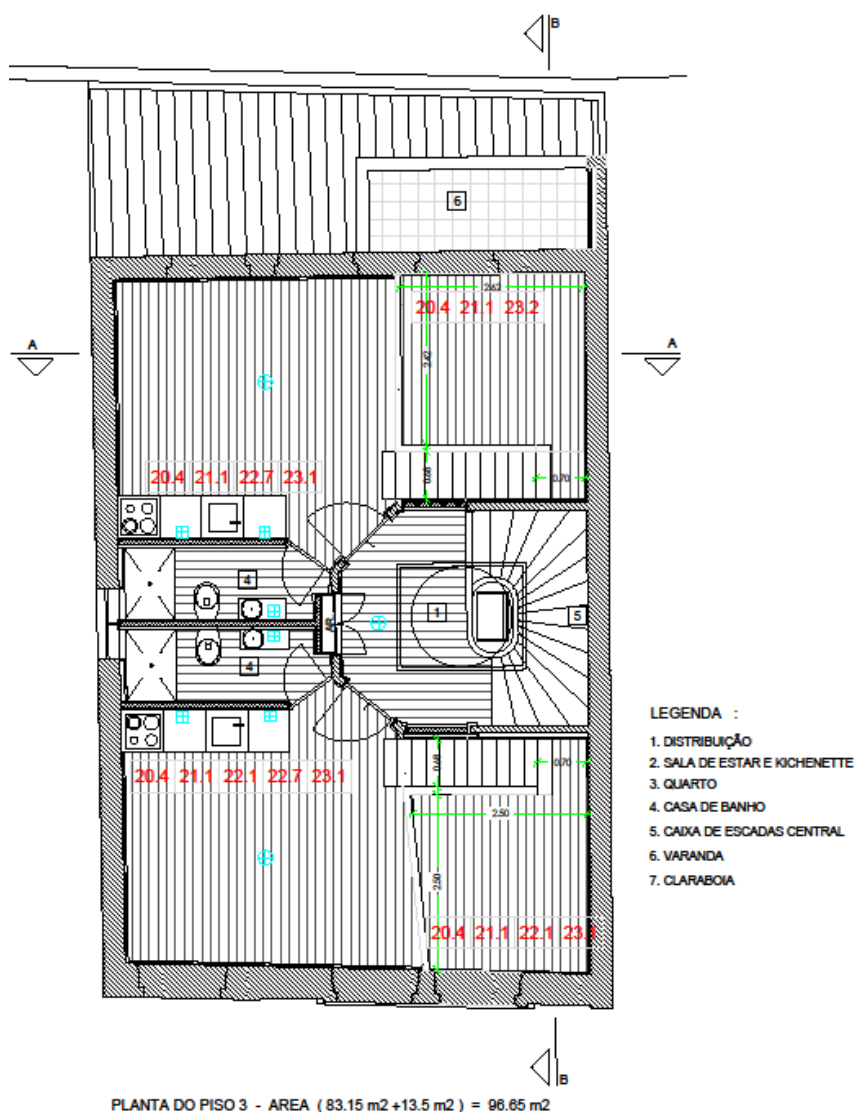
Planta proposta do piso 3 "mezzanine"
